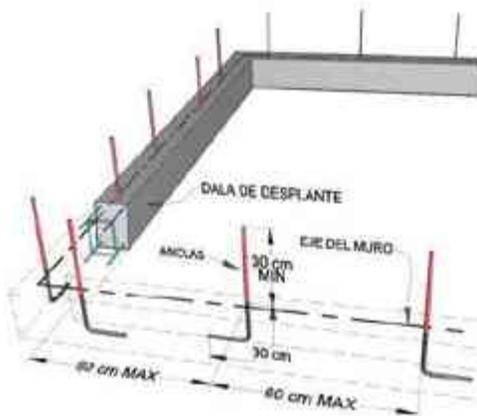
Vista Sistema Constructivo PANEL W. Recuperado de URL.<http://panelw.com/pics/manual-instalacion-ilustrado-pw-2013-es.pdf>
